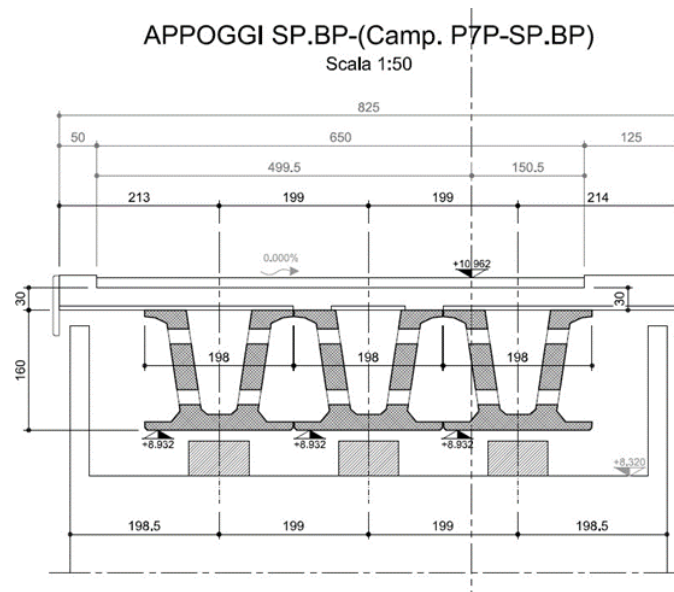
Sezione trasversale Campata 8 (a 3 travi) – Rampa P – SP_BP
